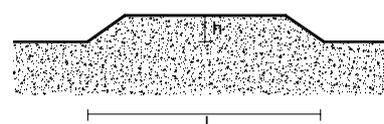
DIMENSIONES BADÉN TRAPEZOIDAL
